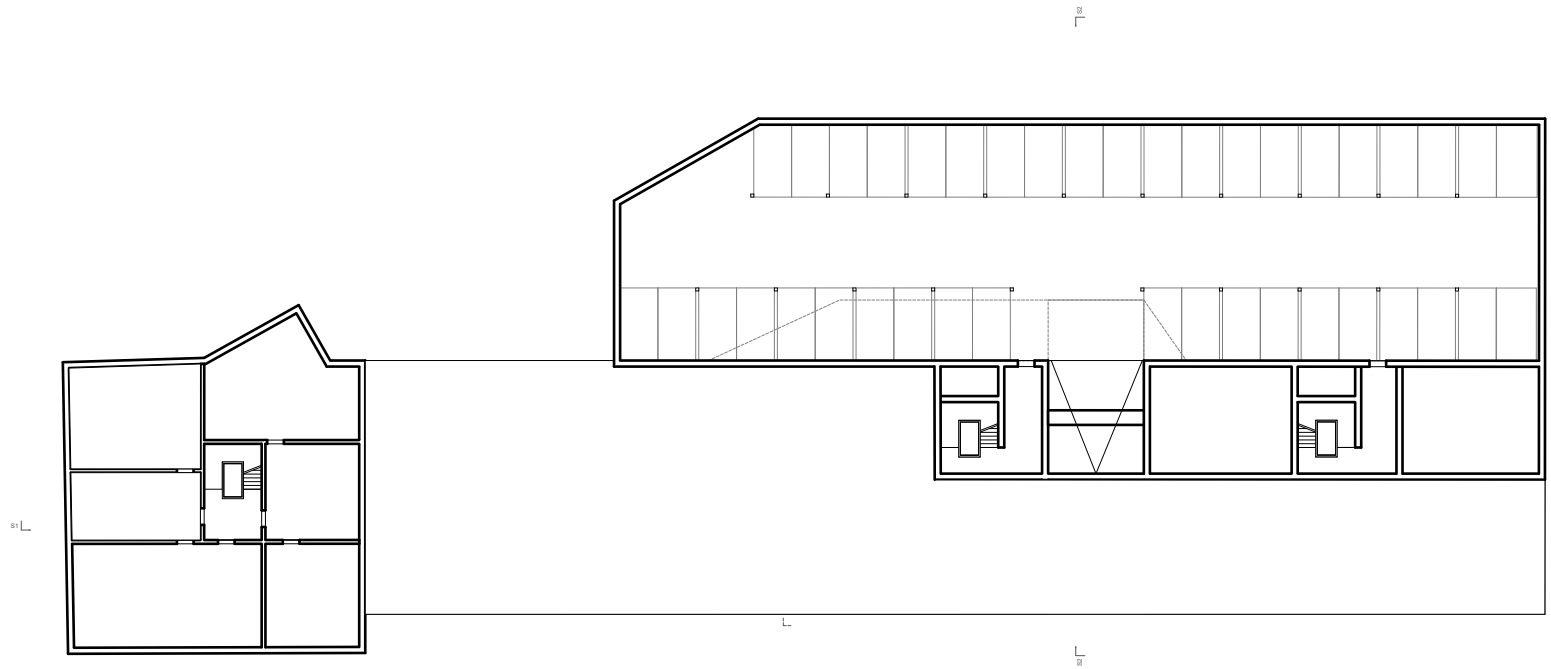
Konzeptskizze Grundriss - Anfangsphase
